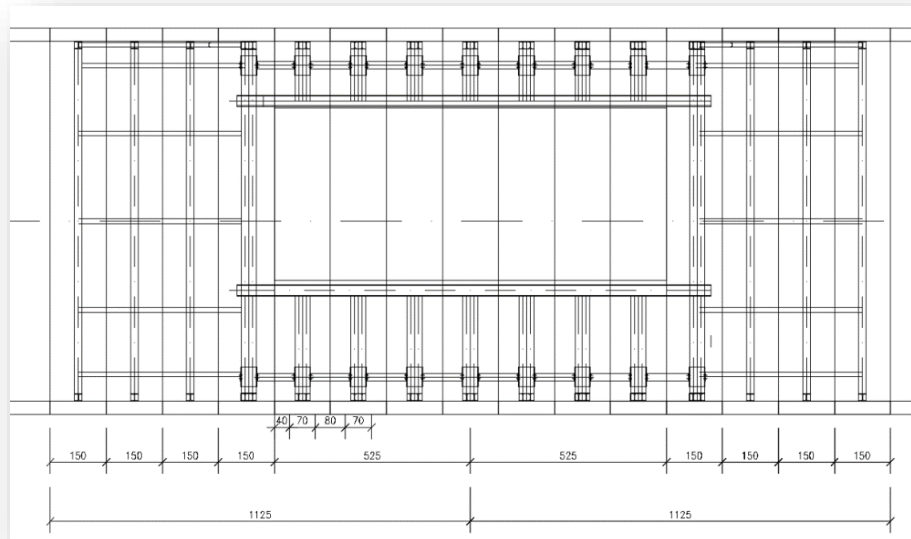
Cadru de armare din oțel în corespondență cu tăierea segmentelor de căptușeală a tunelului de metrou
